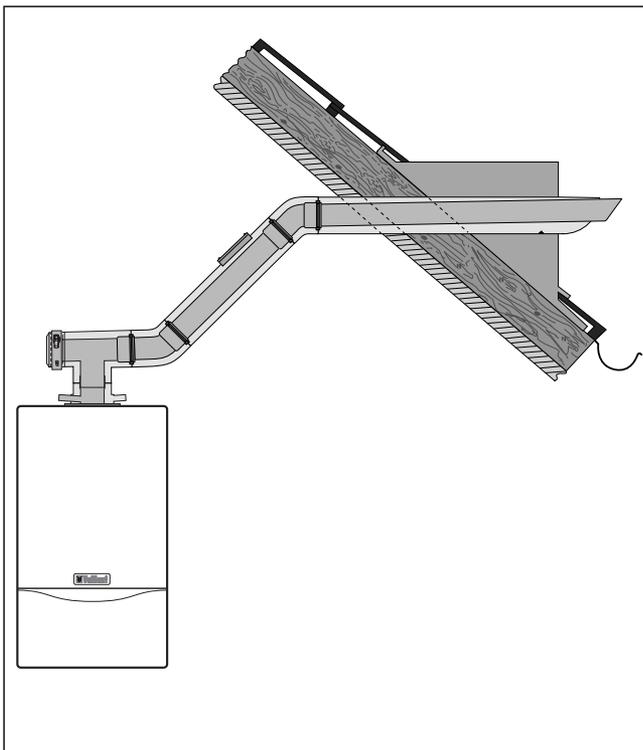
Montagebeispiel: Waagerechte Dachdurchführung
